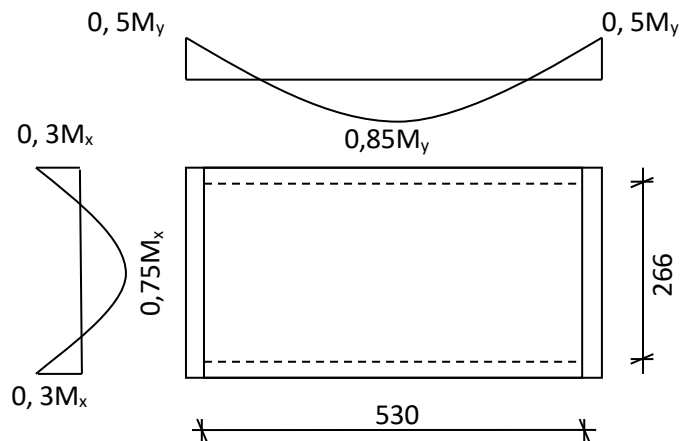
Panneau de dalle appuie sur 4 coté
